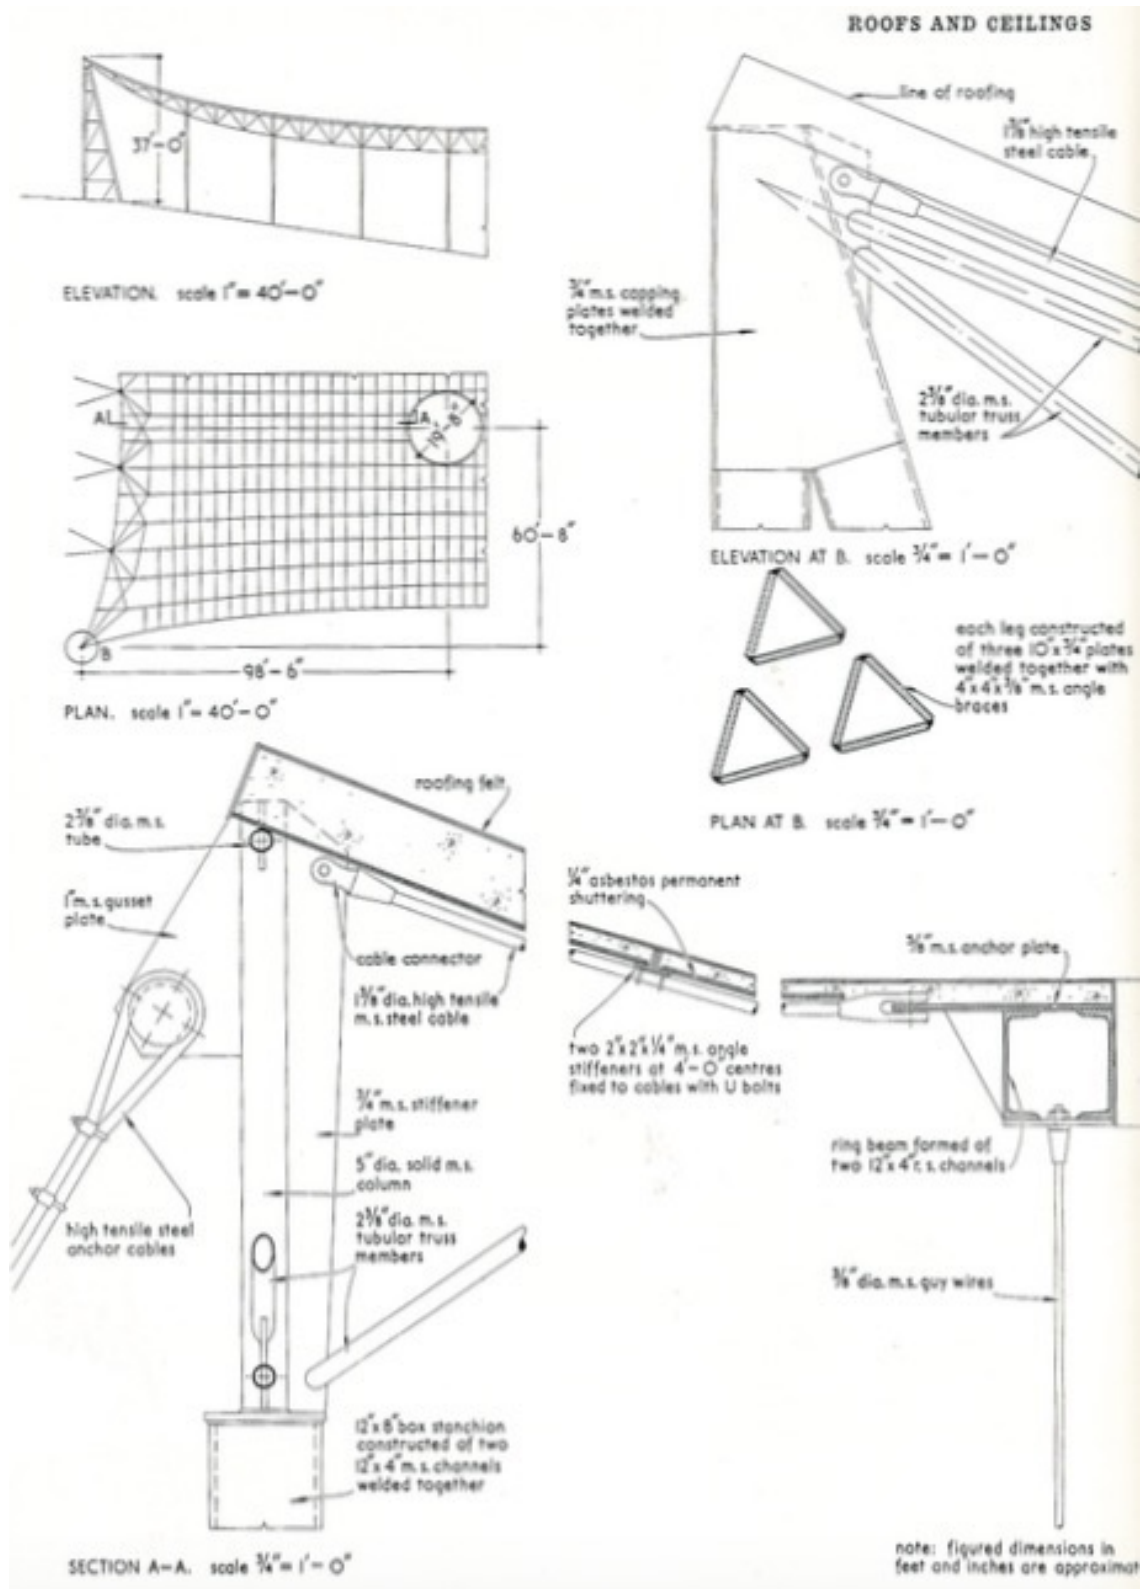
Detalhamento projeto estrutural. Paulo Fragoso. FONTE: NOBRE, 2008.
